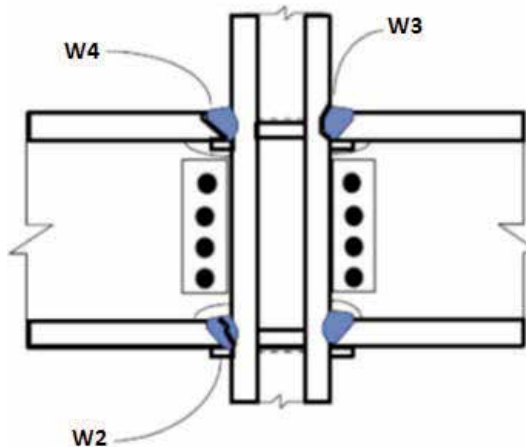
Tipos de daños en soldadura (Fuente: FEMA 351)
